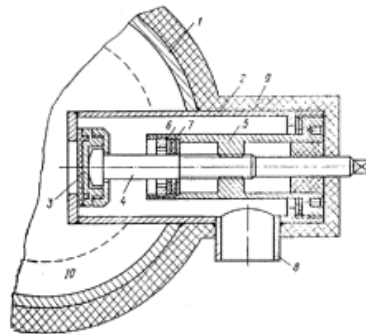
Конструкция выпуска воды при оледенении трубопровода на 50 % (1 - трубопровод; 2 - корпус арматуры; 3 - клапан; 4 - шпindel; 5 - ходовая гайка; 6 - нажимная гайка; 7 - уплотнение шпинделя; 8 – выпускной патрубок; 9 - теплоизоляция; 10 – лед)
